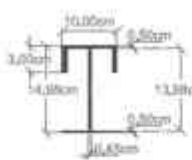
Detalle de Estructura. Obtenida de planos realizados por el autor.
